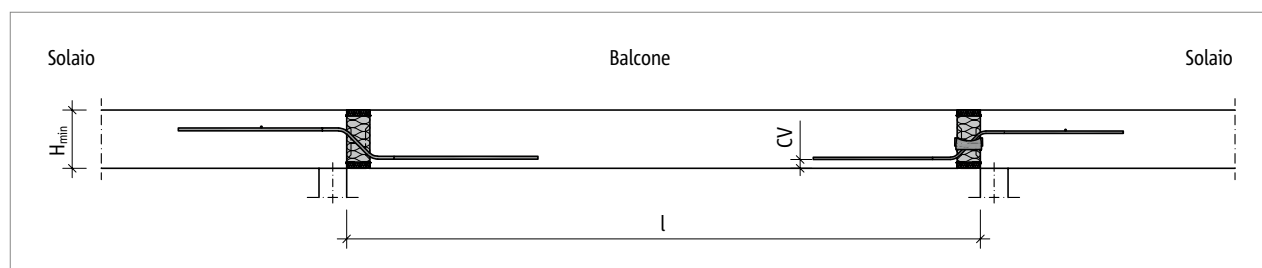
Schöck Isokorb® T tipo Q-Z V5 - V10, Q V5 - V10: schema statico
